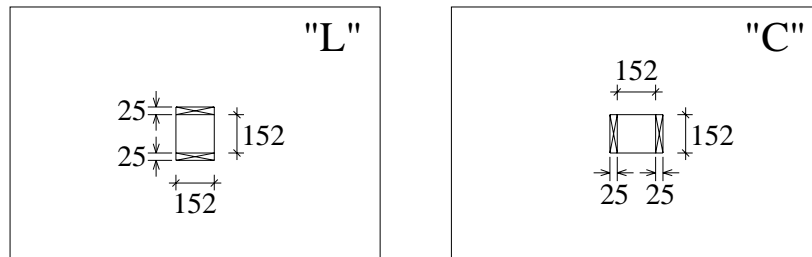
Furos nas lajes de HANSON & HANSON (1964) (mm)
